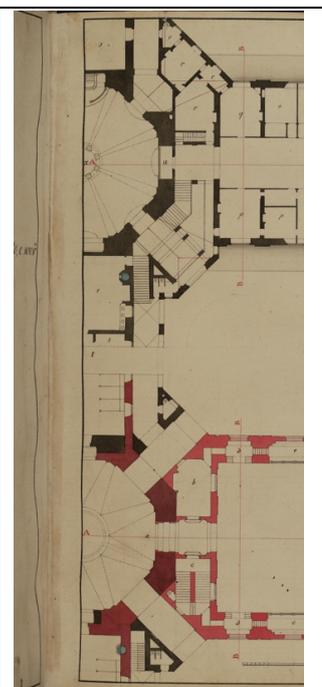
stralcio pianta del livello terra e del primo livello della Rotonda, progetto originale del 1763 - fonte: Archivio di Stato
